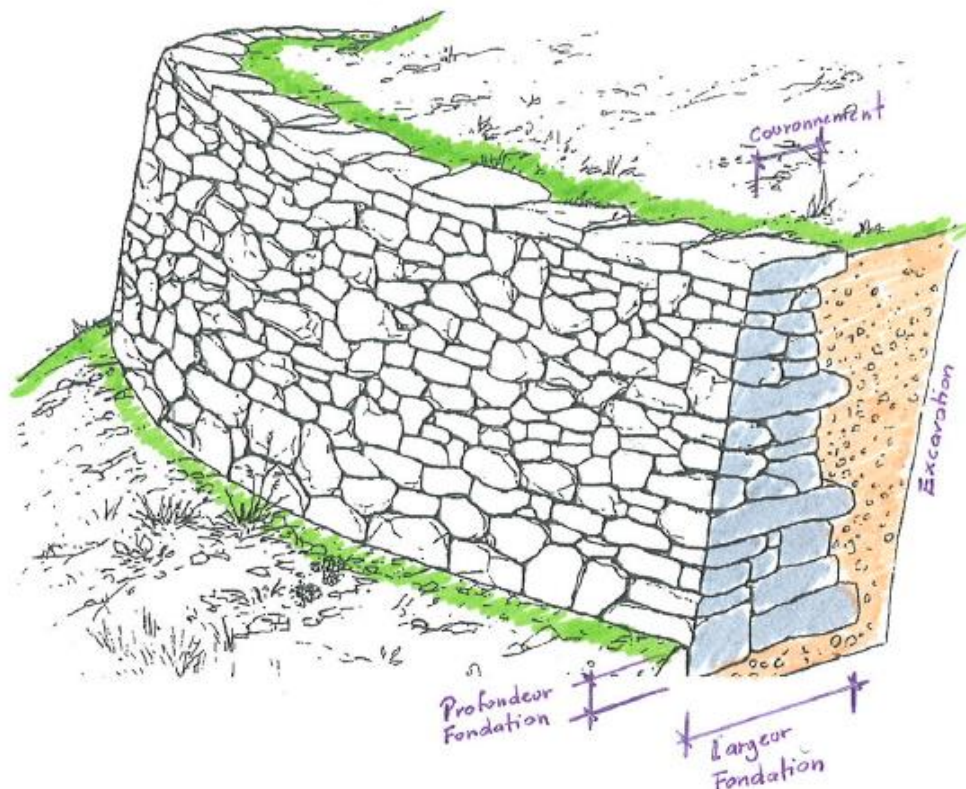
schéma illustratif du profil-type d'un mur en pierre sèche
